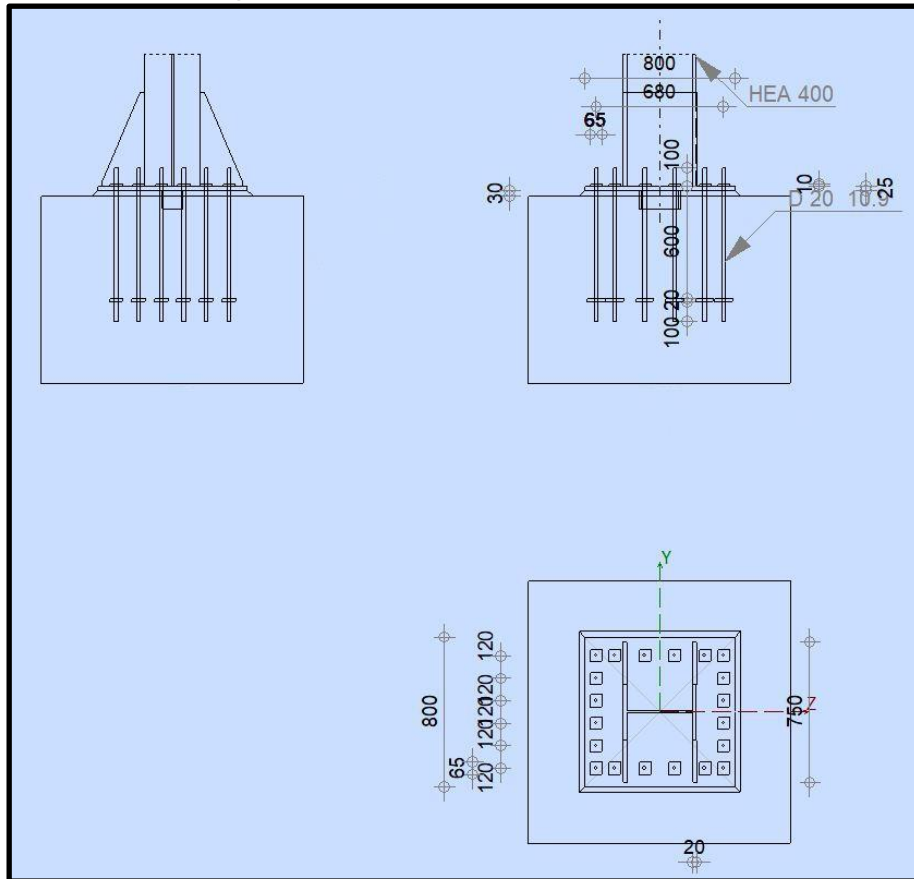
Schéma d'assemblage pied de poteau HEA 400
